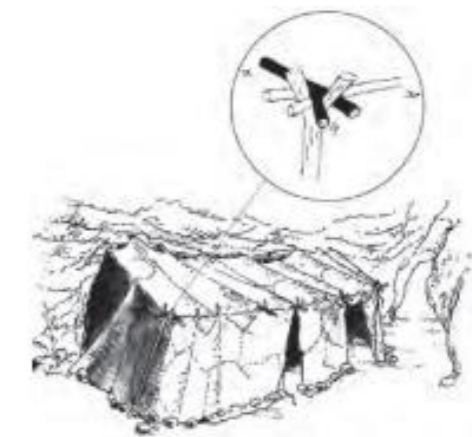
Ilustración de una Choza con detalle del autor con nódulos estructurales de Lazaret.
